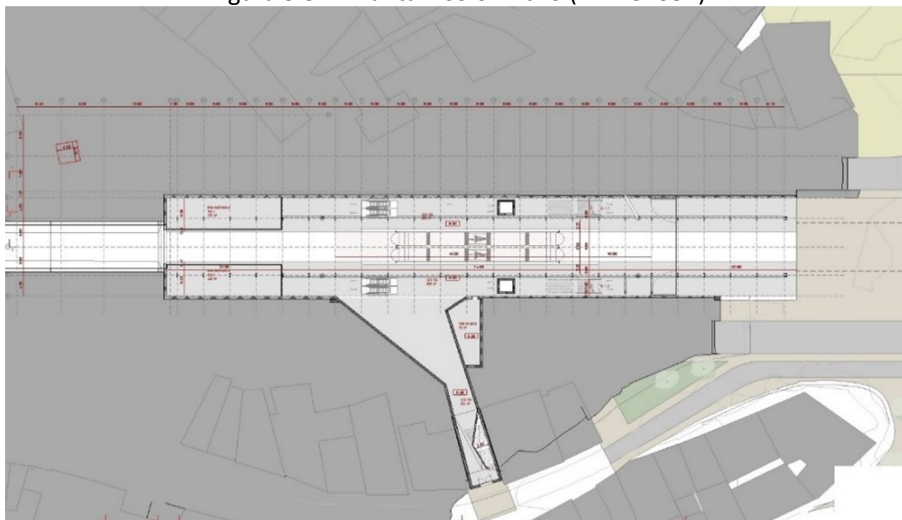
Planta Piso -1 - Cais Lios (ML 134353)
